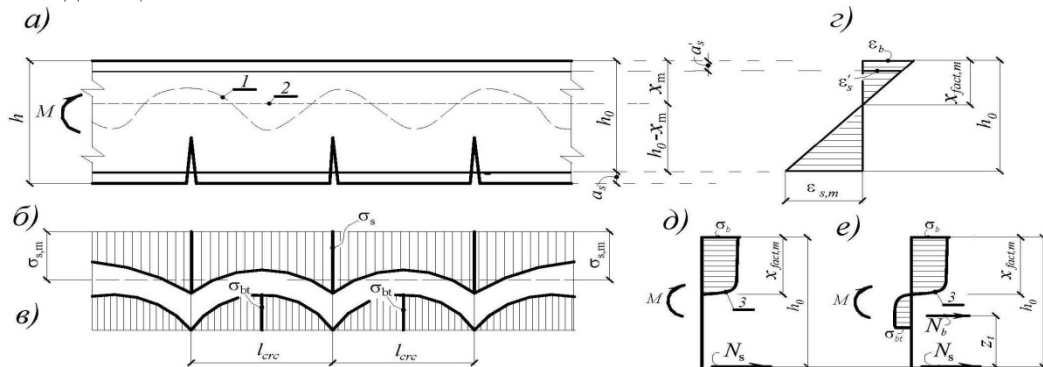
Типичные картины деформирования бетона и арматуры в железобетонном элементе с трещинами по теории В. И. Мурашева и Я. М. Немировского: а – схема образования трещин; б, в – эпюры напряжений в растянутой арматуре и растянутом бетоне; г – гипотеза плоских сечений; д – внутренние усилия в сечении с трещиной по теории В. И. Мурашева; е – внутренние усилия в сечении с трещиной по теории Я. М. Немировского с учетом работы растянутого бетона над трещиной
